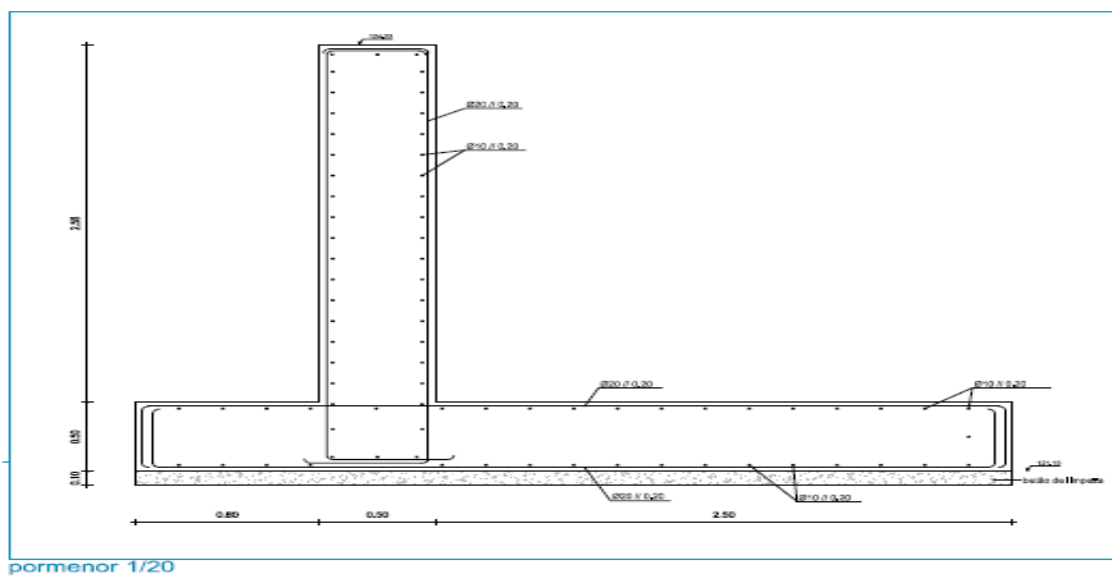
Desenho de pormenor do muro em betão armado. [11]
